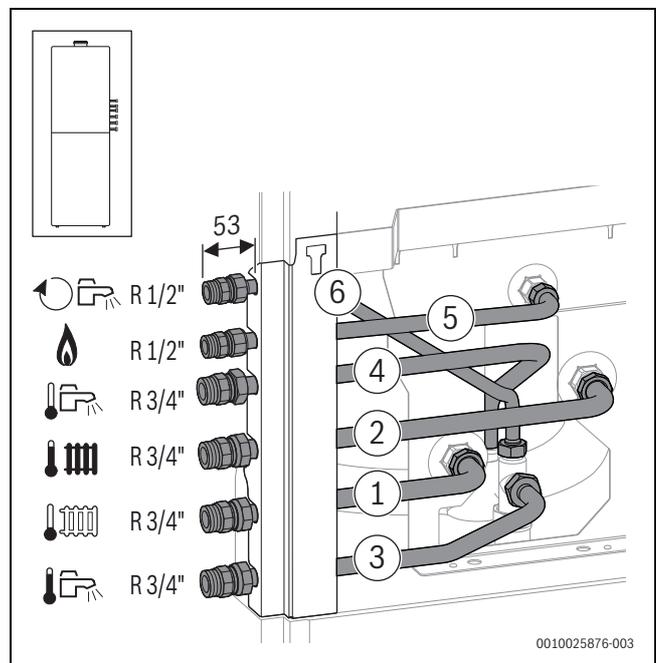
Vue côté arrière (dimensions en mm) : accessoire CS 10 monté sur le côté droit
